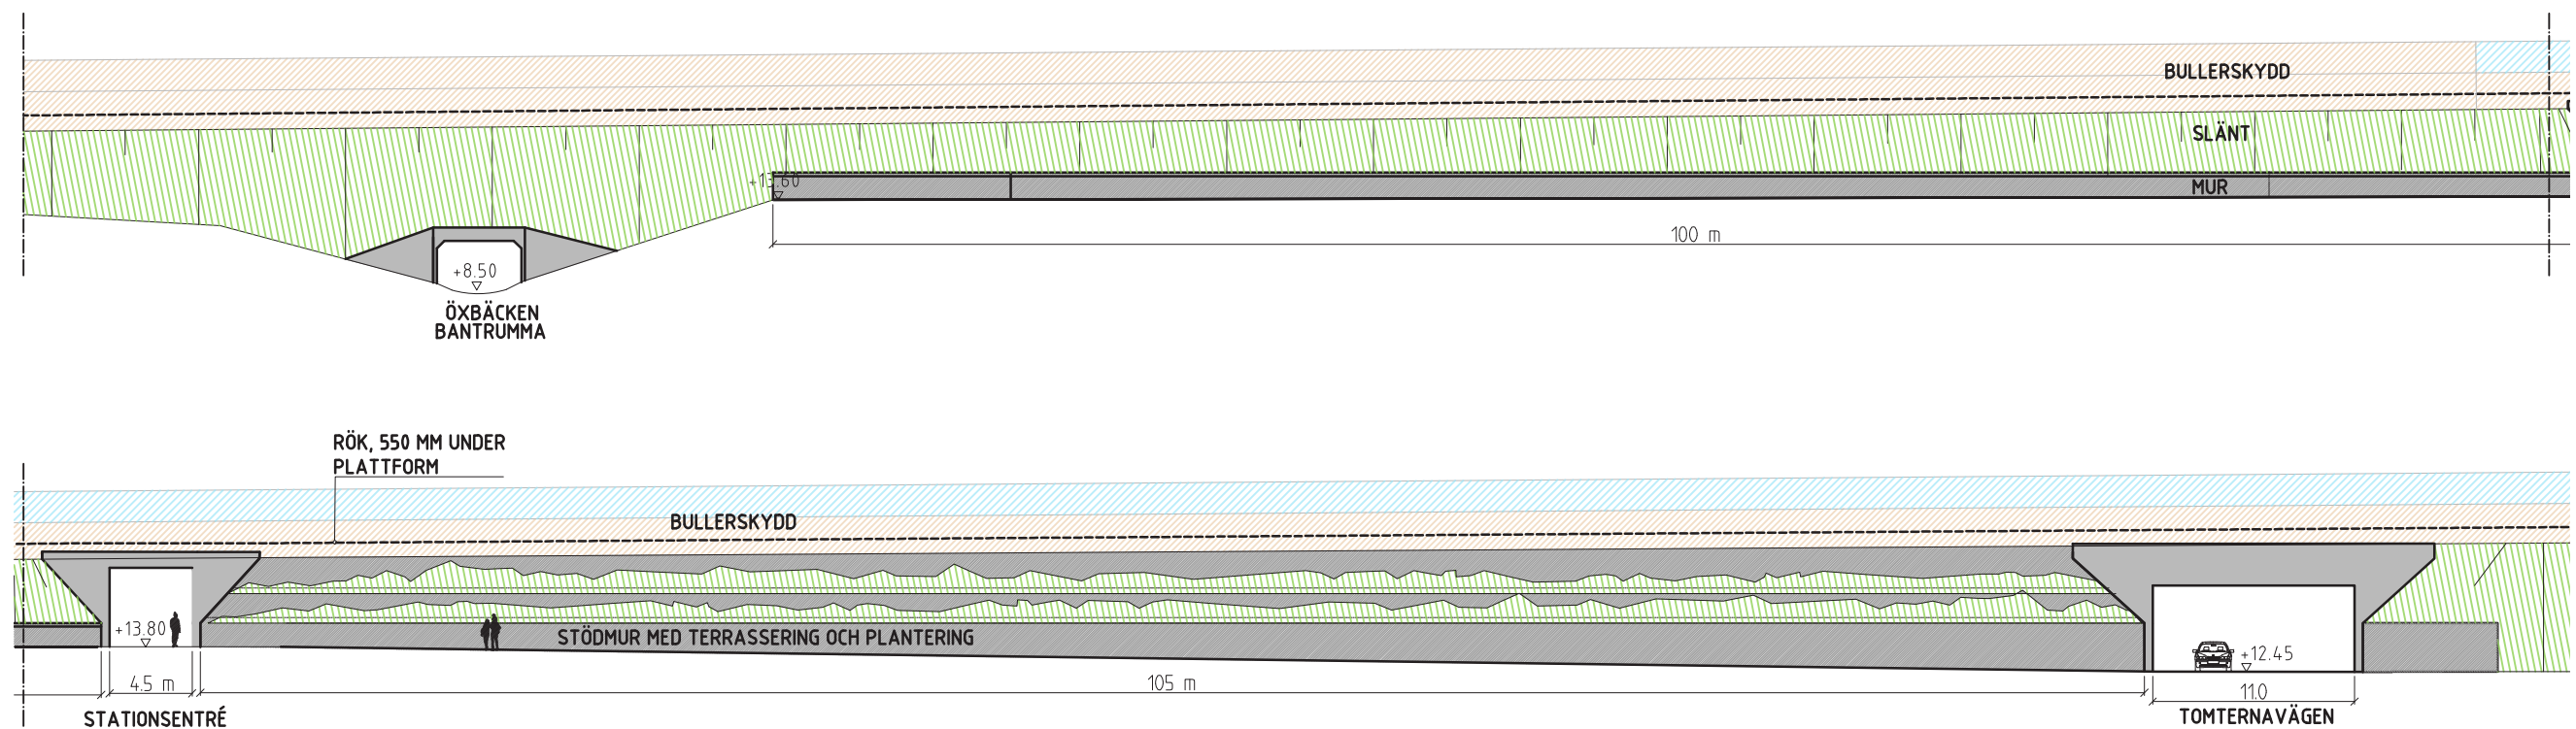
Sektion, Mur och slänt (1:3) mellan stationsentré och Öxbäcken
